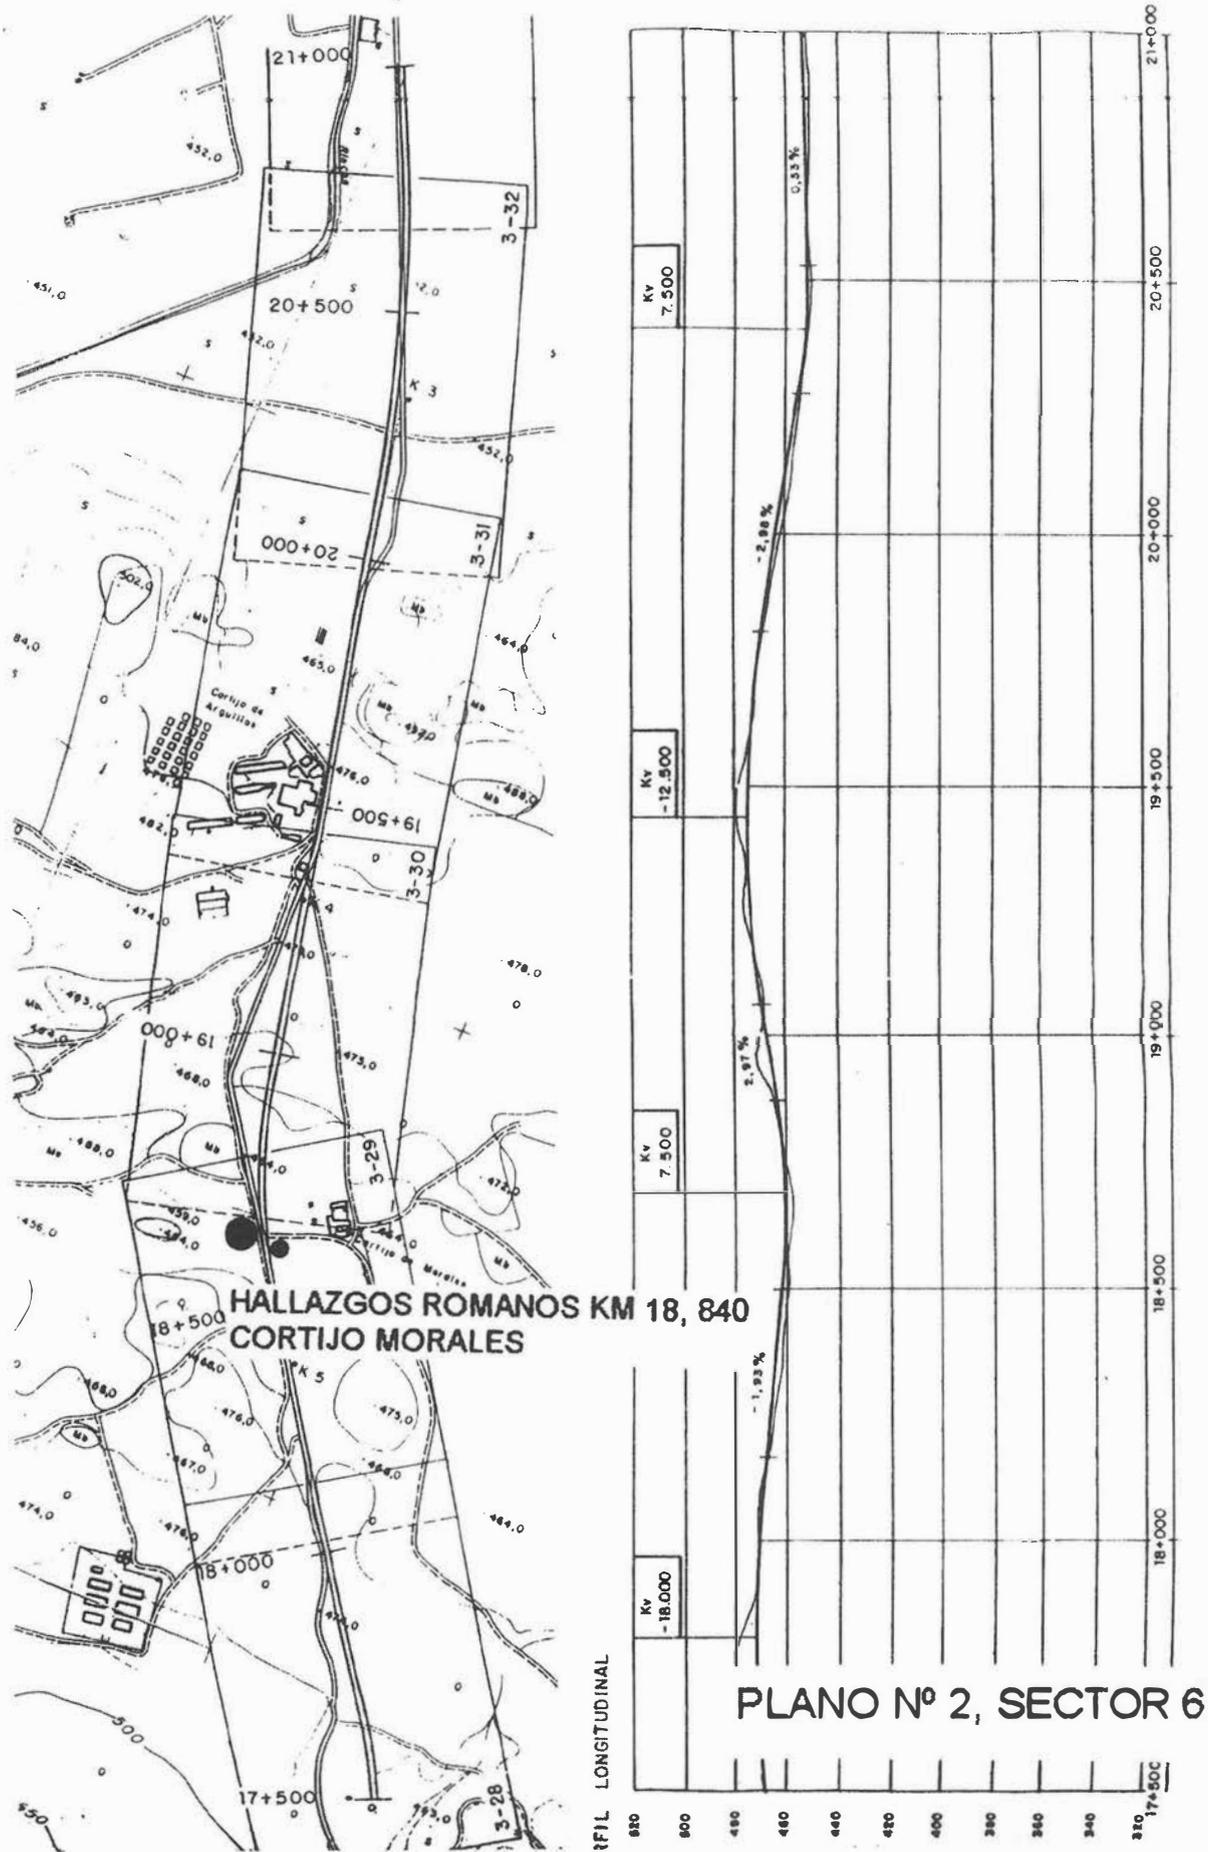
Planta y sección de la traza con ubicación del Cortijo Morales.
